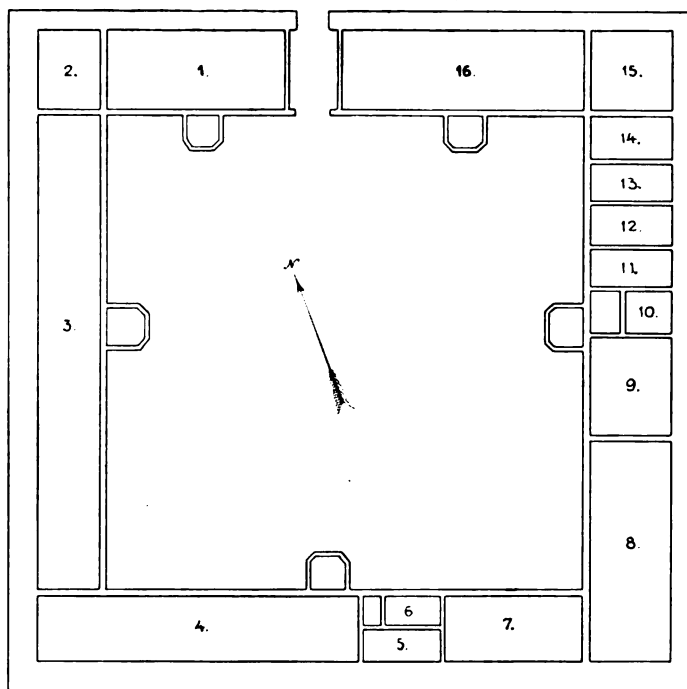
Det yngre Krogen. Plan af Stueetagen.
